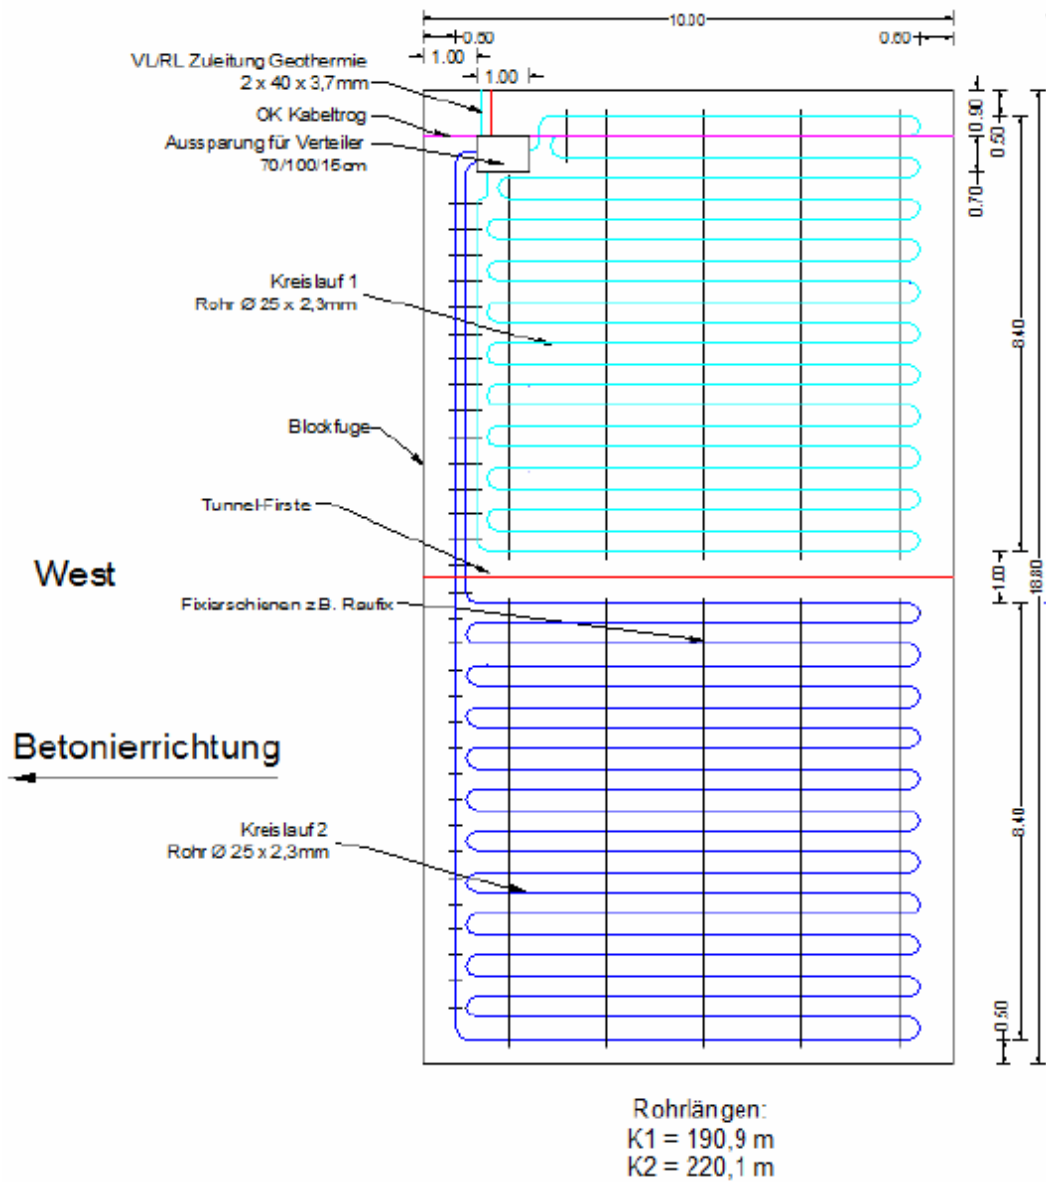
Verlegeschema Teststrecke Stuttgart - Fasanenhof [2]
